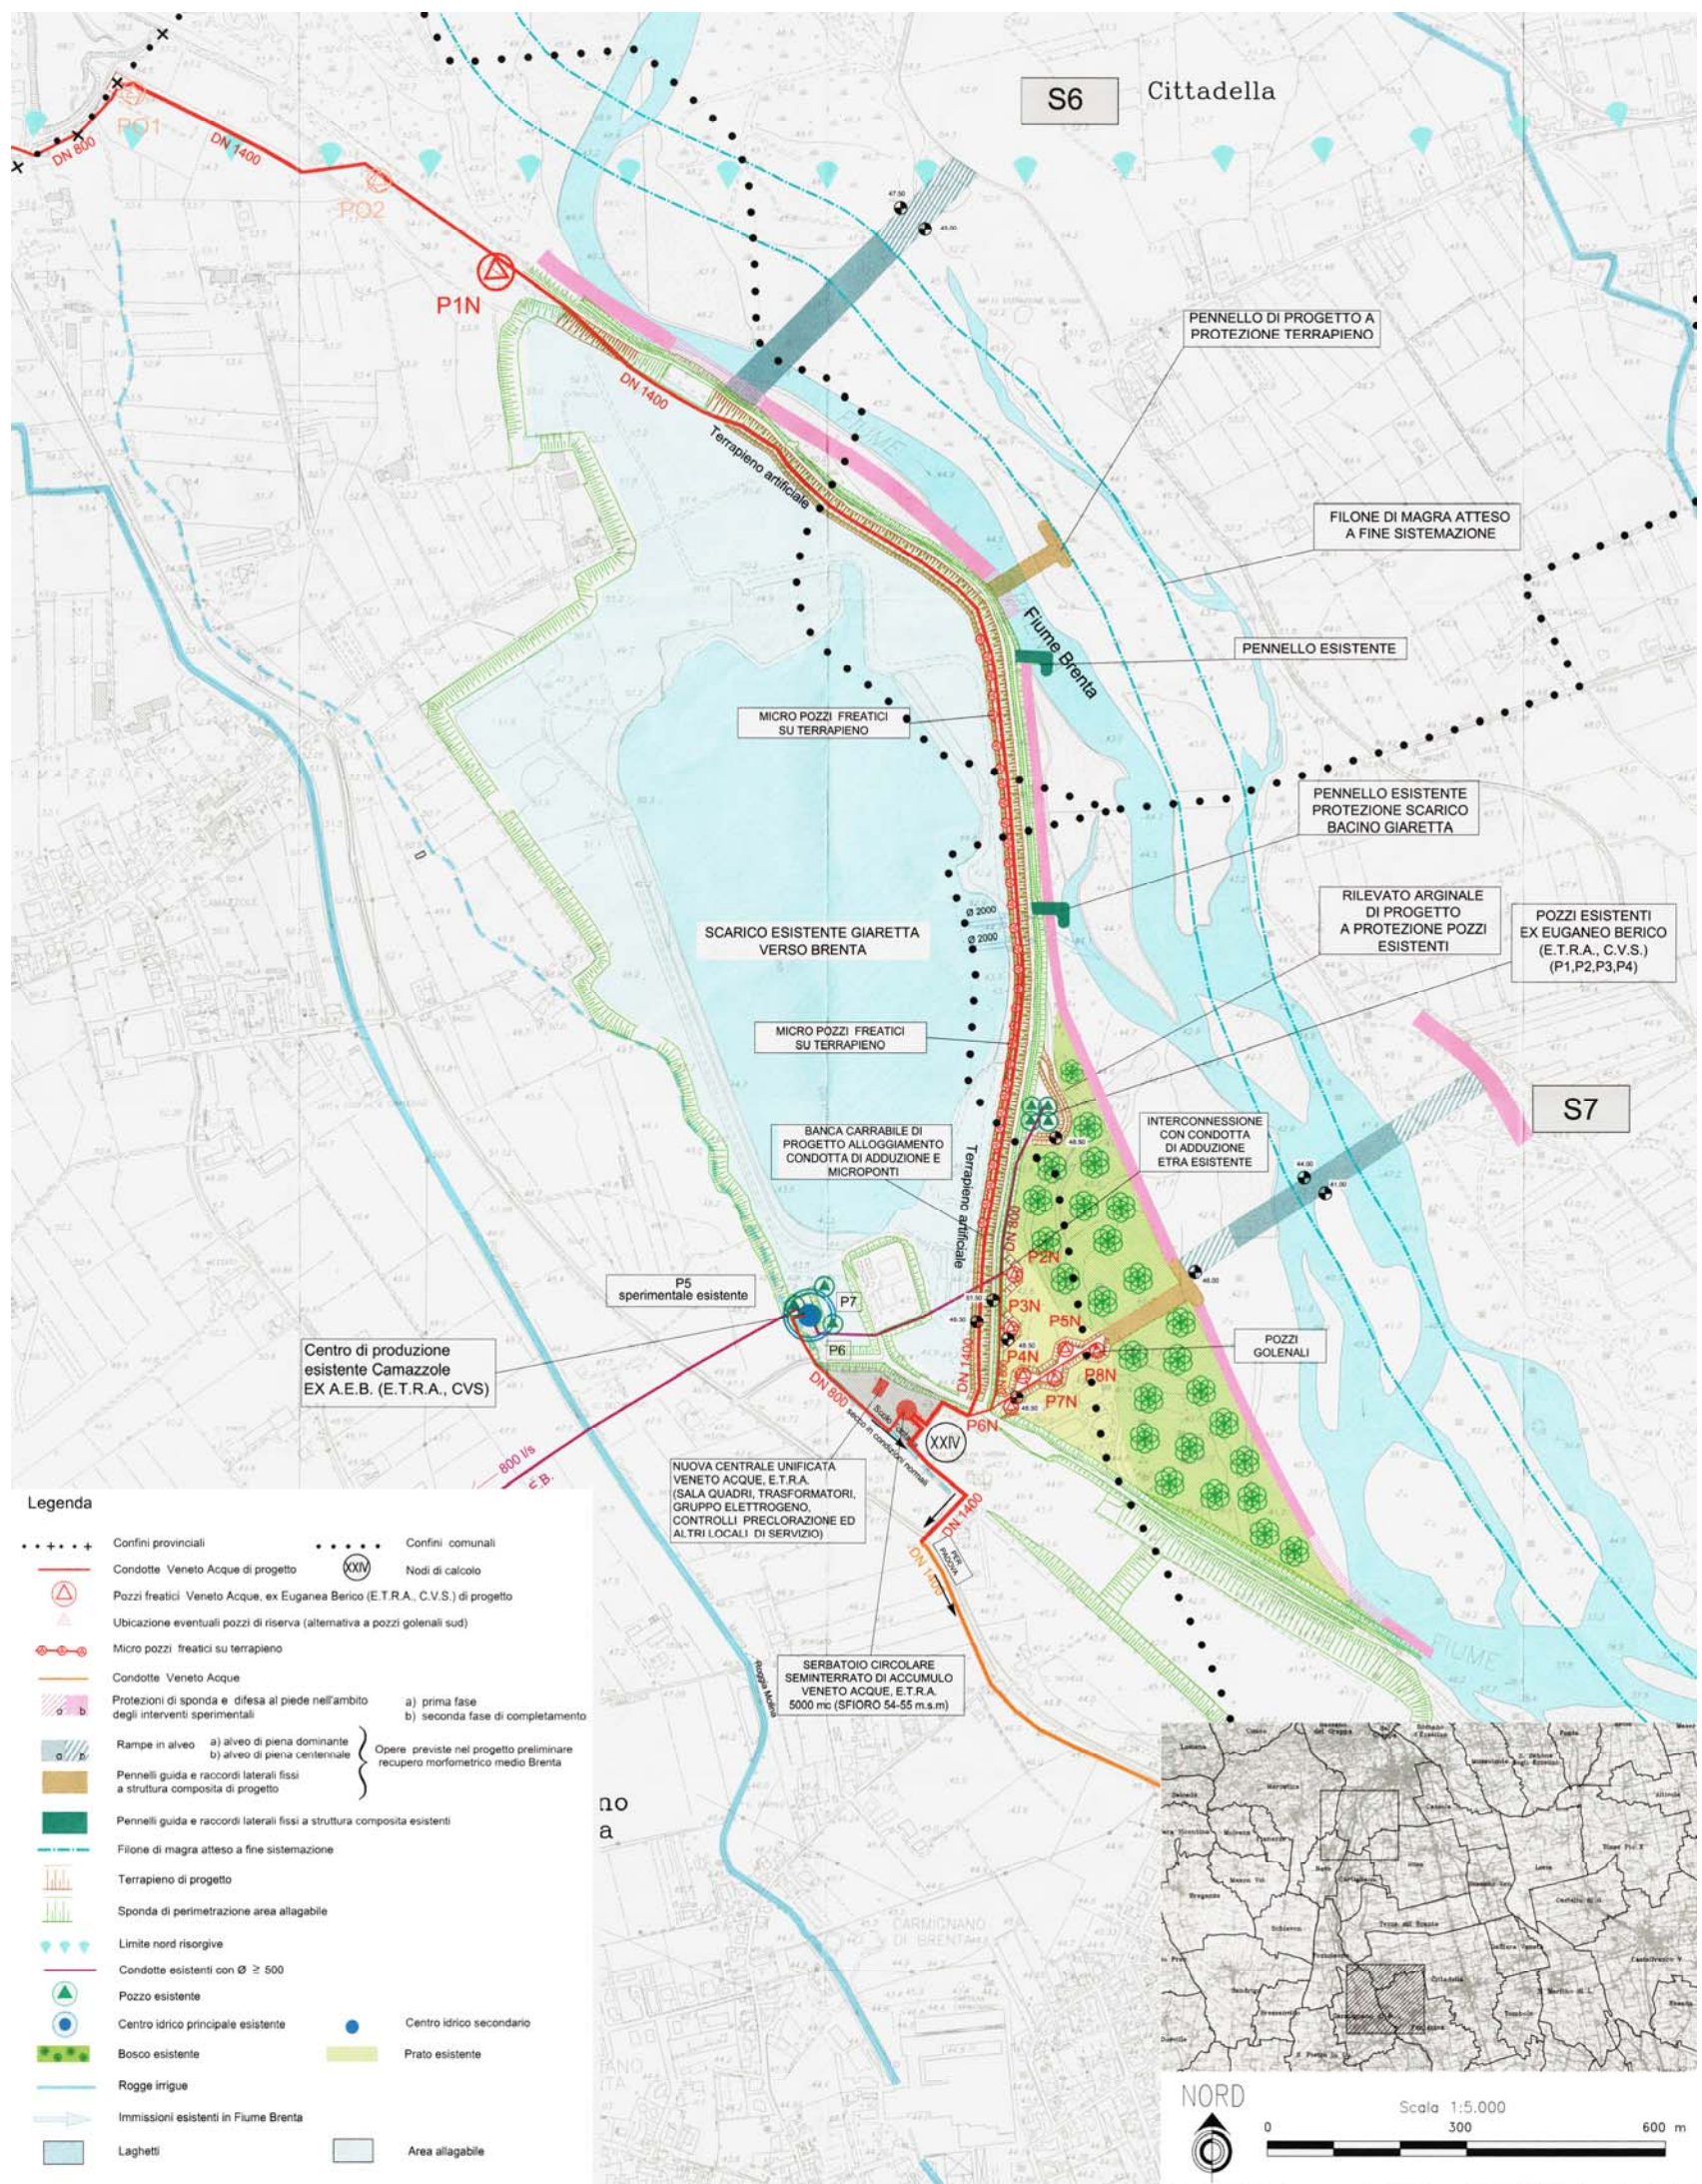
Planimetria delle opere di prelievo unificato a Camazzole (estratto dalla Tavola 6.2 del Progetto preliminare).
